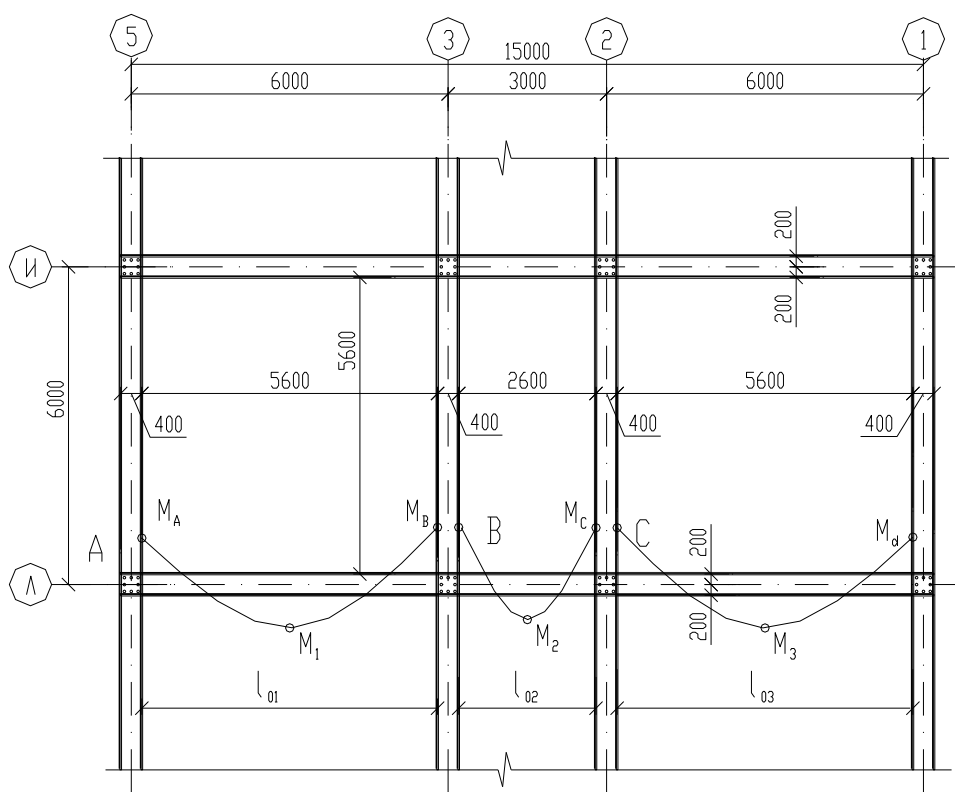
Расчетная схема монолитного перекрытия
